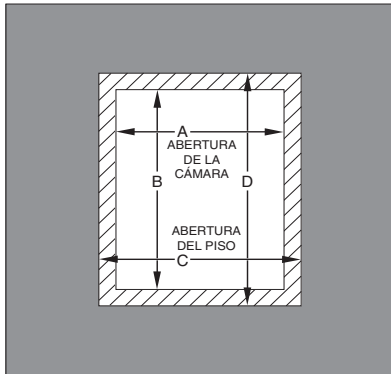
Dimensiones de las aperturas del piso y la cámara
